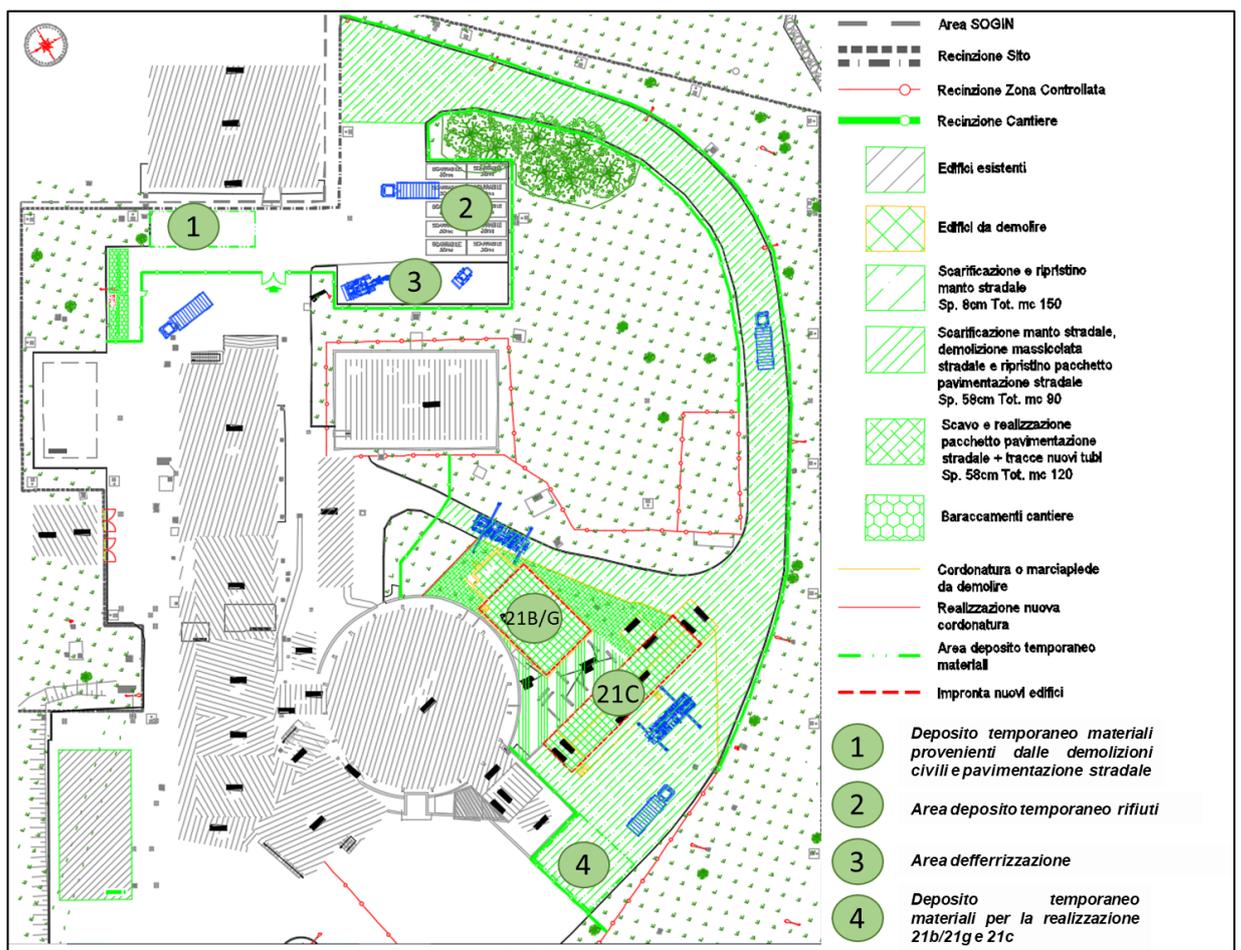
Adeguamenti edifici 21b/21g e 21c – Cantierizzazione
